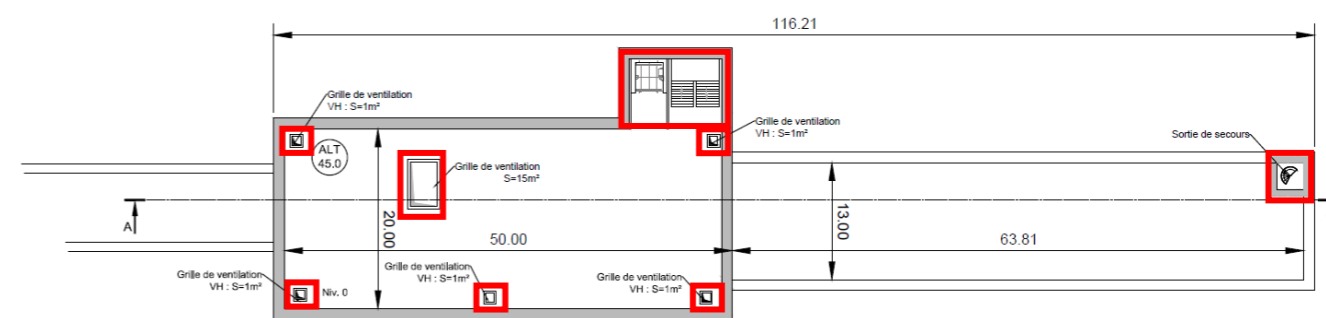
Plan du niveau inférieur du CDT (Source : RATP)
